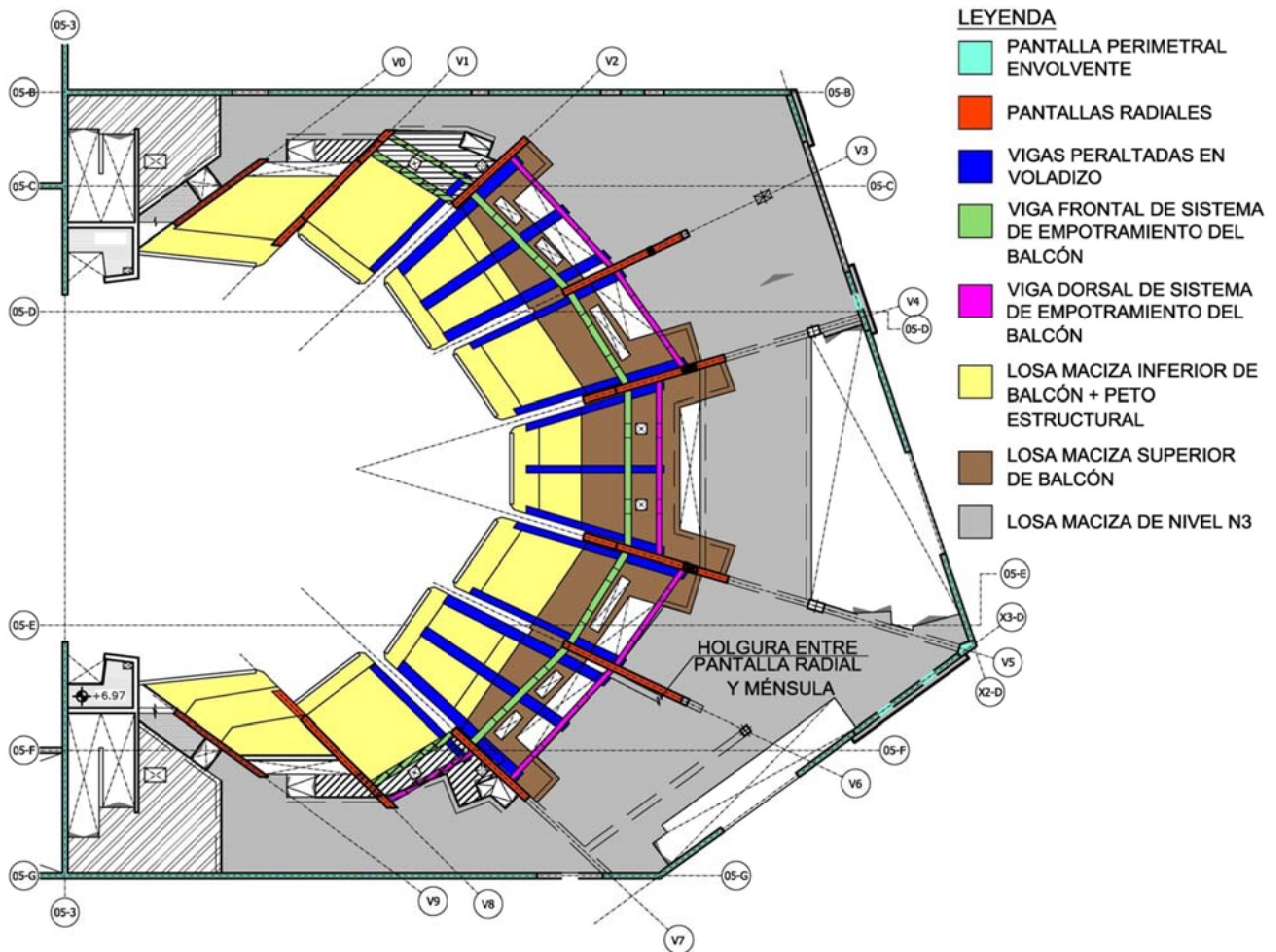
Gran Teatro – vista en planta del esquema estructural principal de la sala
